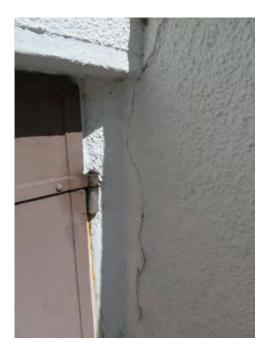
Kelleraußentreppe rückwärtig Rissbildung
